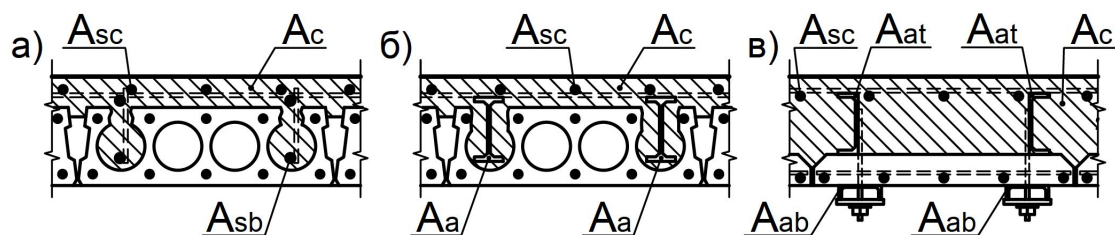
Варіанти підсилення переkritтів приміщень сховищ із збірних залізобетонних плитних конструкцій шляхом збільшення їх перерізів за допомогою: а) арматурних каркасів і сіток; б), в) сталевих профілів і арматурних сіток
